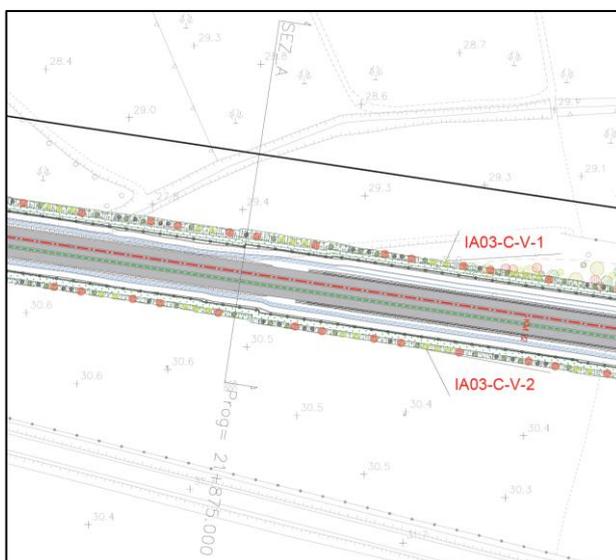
Stralcio planimetrico relativo agli interventi previsti sulle dune, progressiva 21 + 875.000 (estratto planimetria RS39-10-V-ZZ-P7-IA0000-002 Planimetria degli interventi 2/4)
